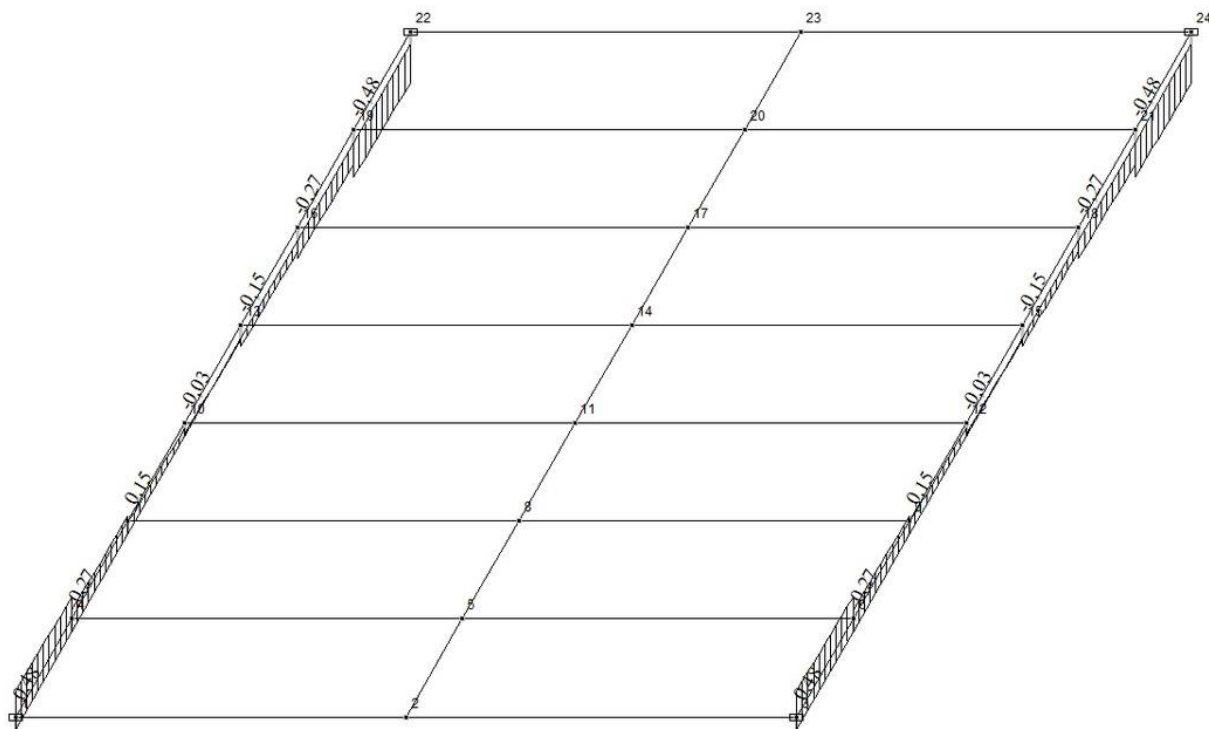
Эпюра по поперечных усилий QZ, кН
